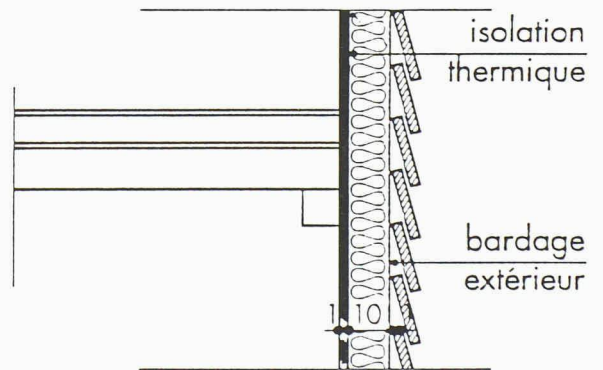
Coupe verticale d'un mur avec isolation extérieure et bardage
